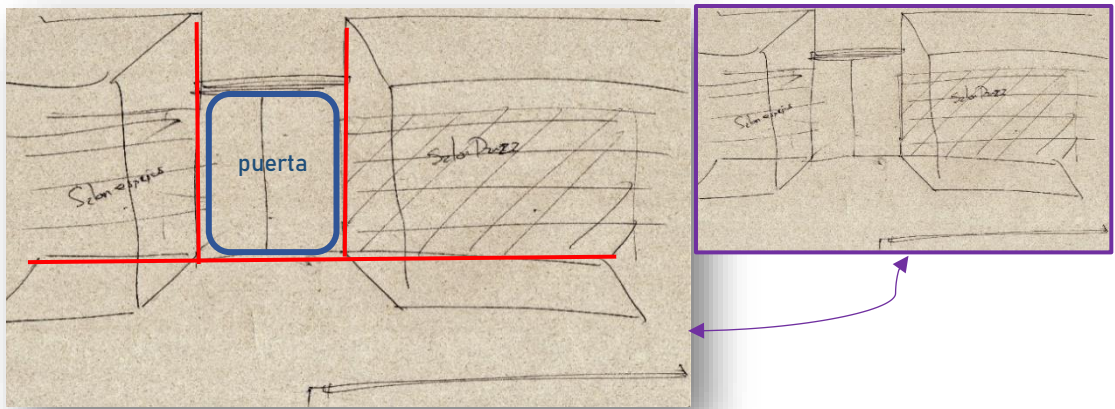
, plano entrada LAV instalación calle 72, egresado EB.
